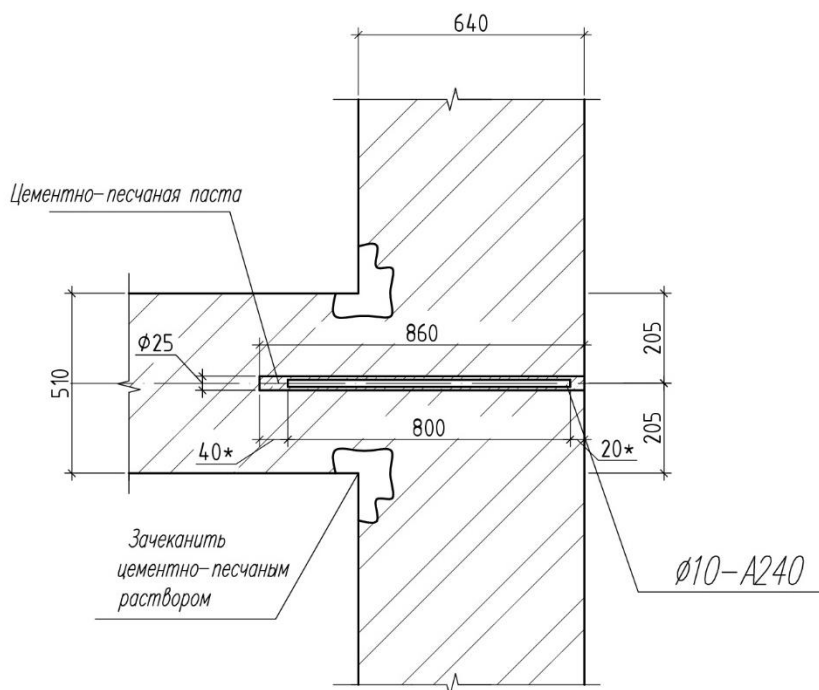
Усиление мест примыкания стен внутренними анкерами
